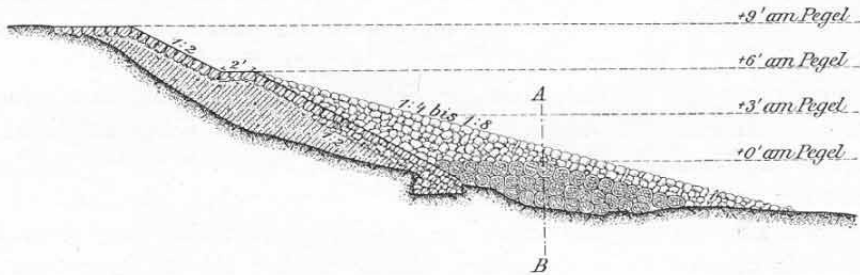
Querschnitt durch das mit Deckwerk und Kopfschwellen ausgebaut Lüttinger Ufer.
